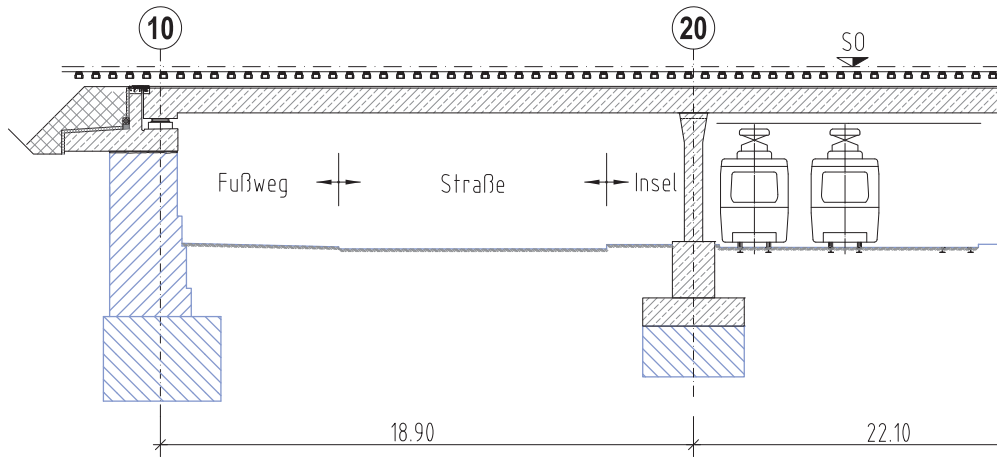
Angebotsentwurf – Bauwerkslängsschnitt
